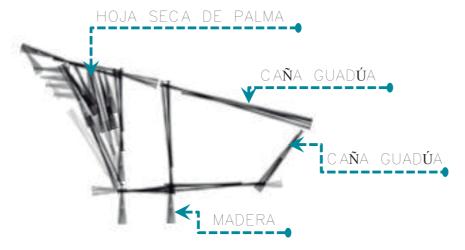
Detalle de fachada lateral. Fuente. Al borde, 2014.
